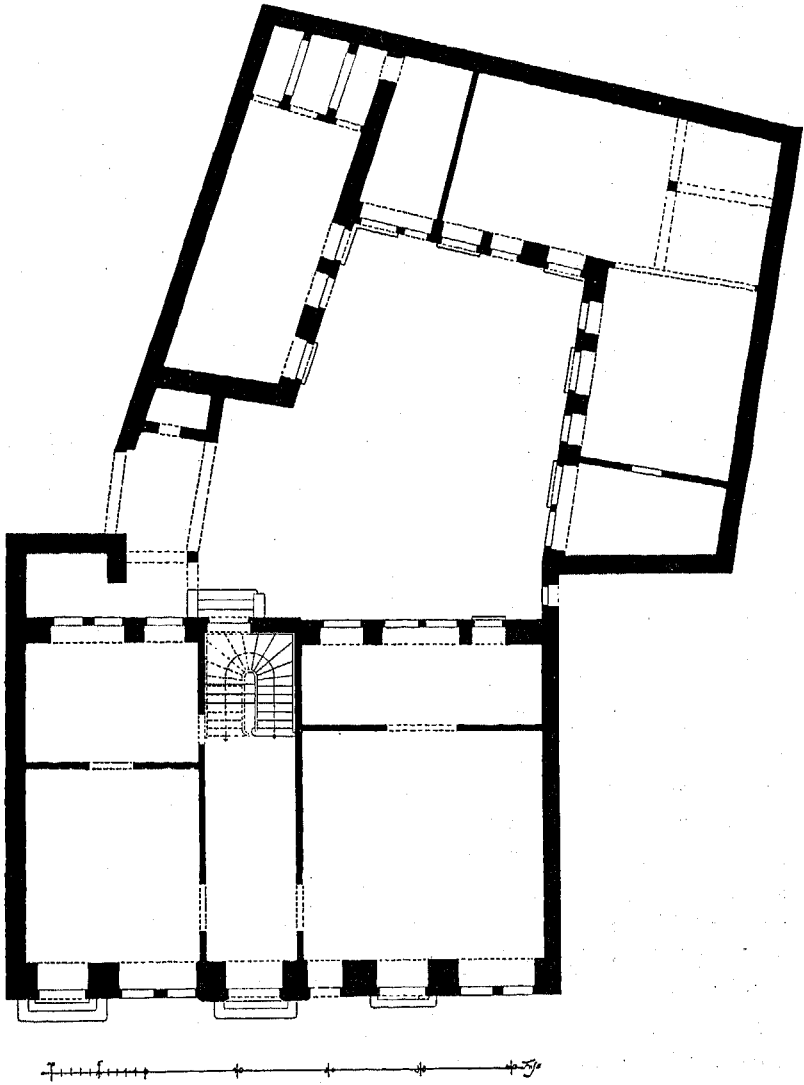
Engelthaler Hof; Grundriss des Erdgeschosses.
